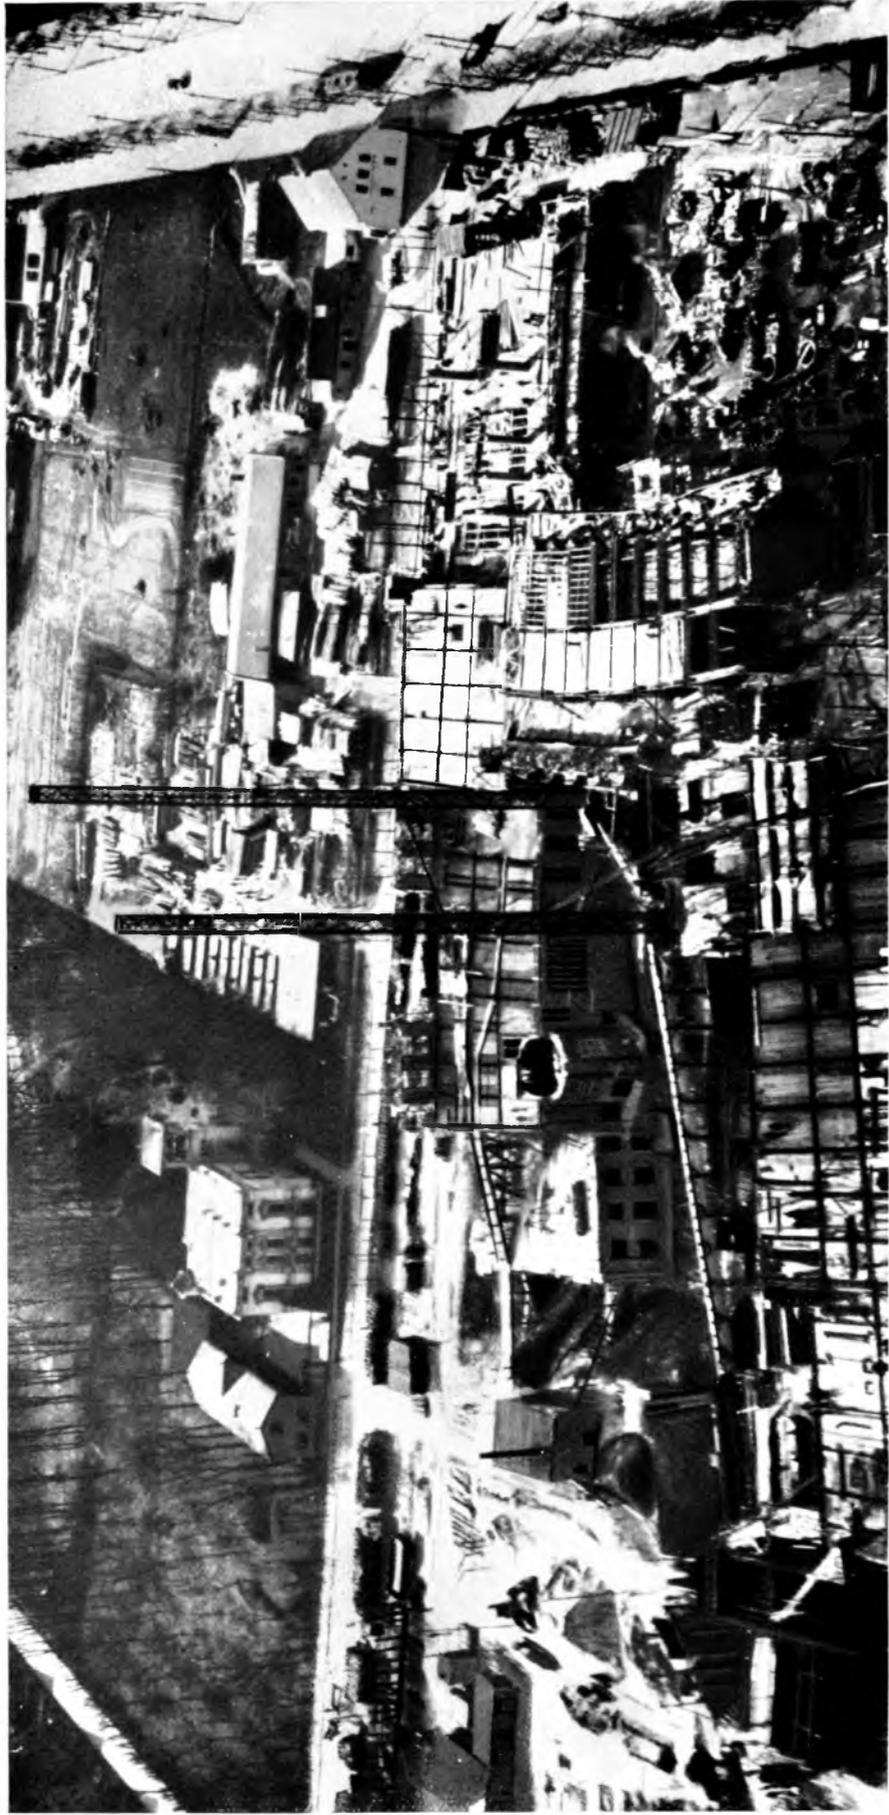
Fliegeraufnahme der Baustelle (siehe Baustellenplan Abb. 55). Man sieht das terrassenförmige Fortschreiten des Baues.
